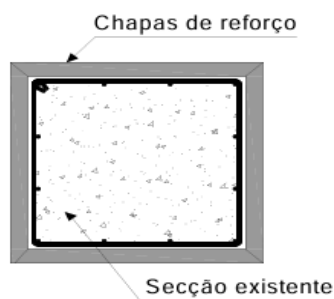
Pilar retangular encamisado com chapas metálicas (17).
